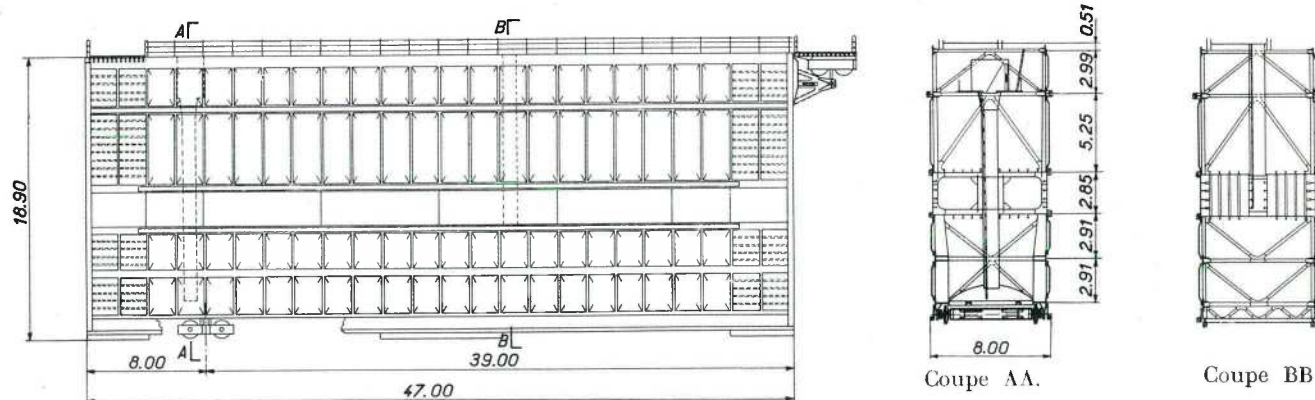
ELÉVATION, COUPE LONGITUDINALE ET COUPES TRANSVERSALES D'UNE PORTE ROULANTE.
